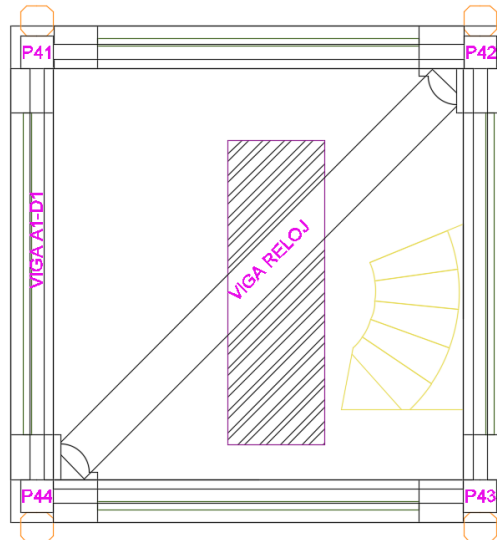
14 Planta estructura cuarto nivel Torre del Reloj de Iquique
